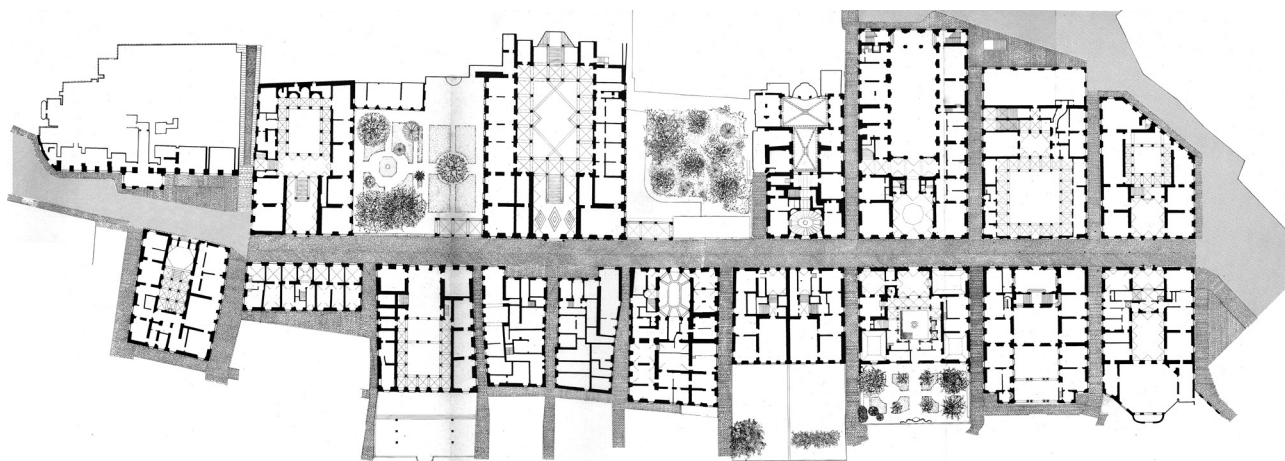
Genova. Via Garibaldi, pianta della strada Nuova a quota del piano terreno (da AA.VV., 1967, p. 65).
